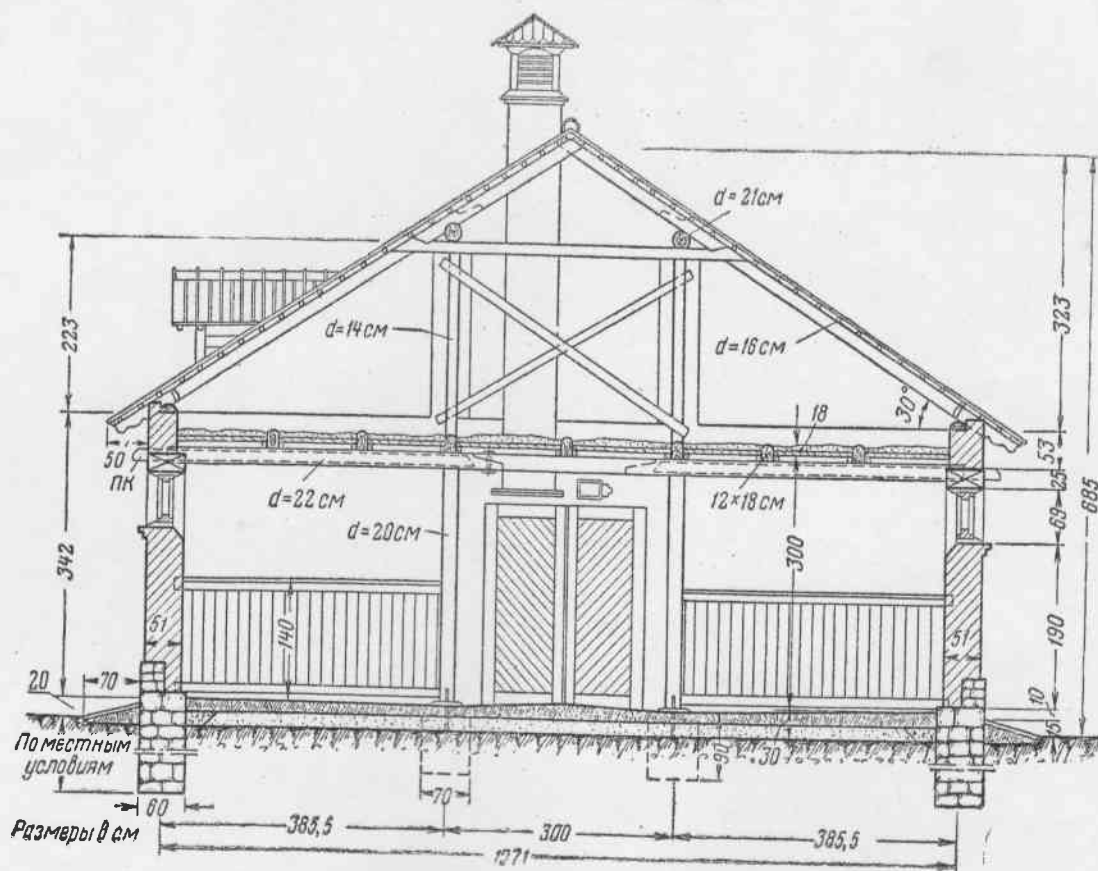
Поперечный разрез конюшни на 40 племенных лошадей.
